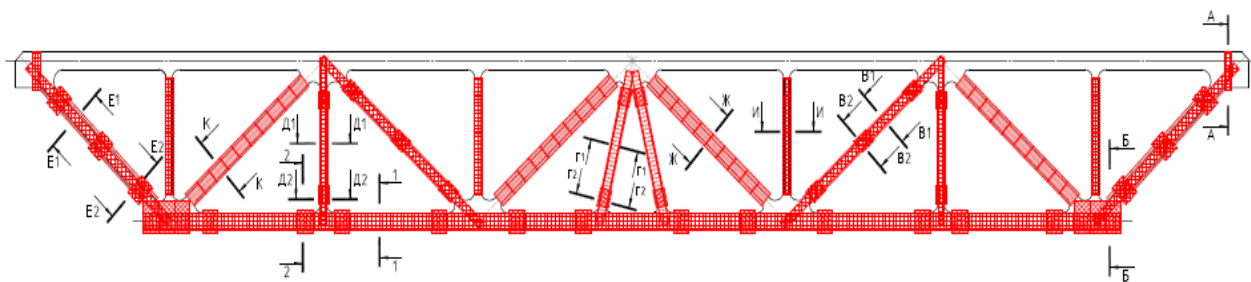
Усиление железобетонной фермы по серии Е-772П1 углеродными лентами CarbonWrap® Tape
